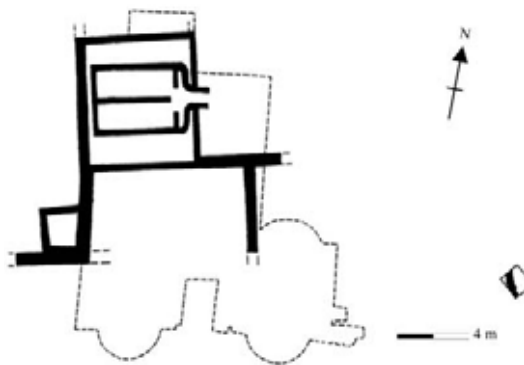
Planta esquemàtica de les termes i planta esquemàtica del forn F2 i de la bassa de decantació d'argiles (López *et al.*, 2002)
